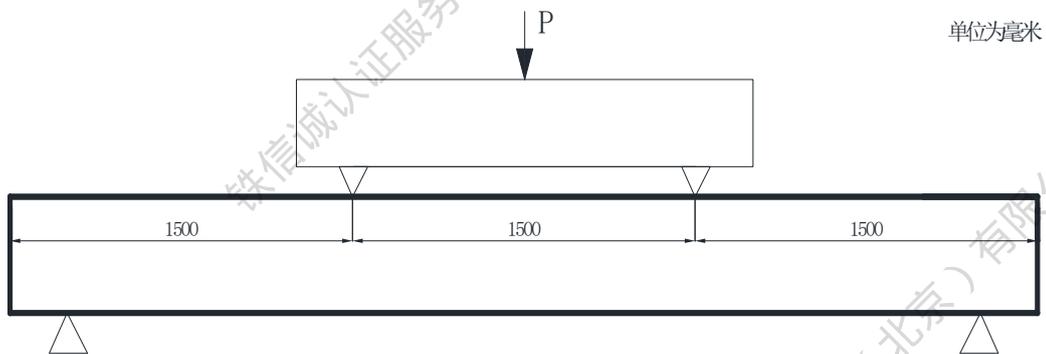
4.5m 钢筋混凝土模型梁加载位置示意
